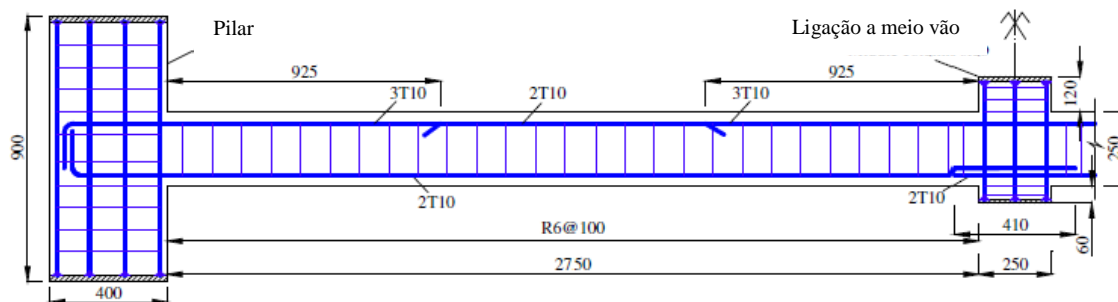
Pormenorização do sistema estrutural S2 - Fonte: adaptado de (Yu and Tan, 2013)
